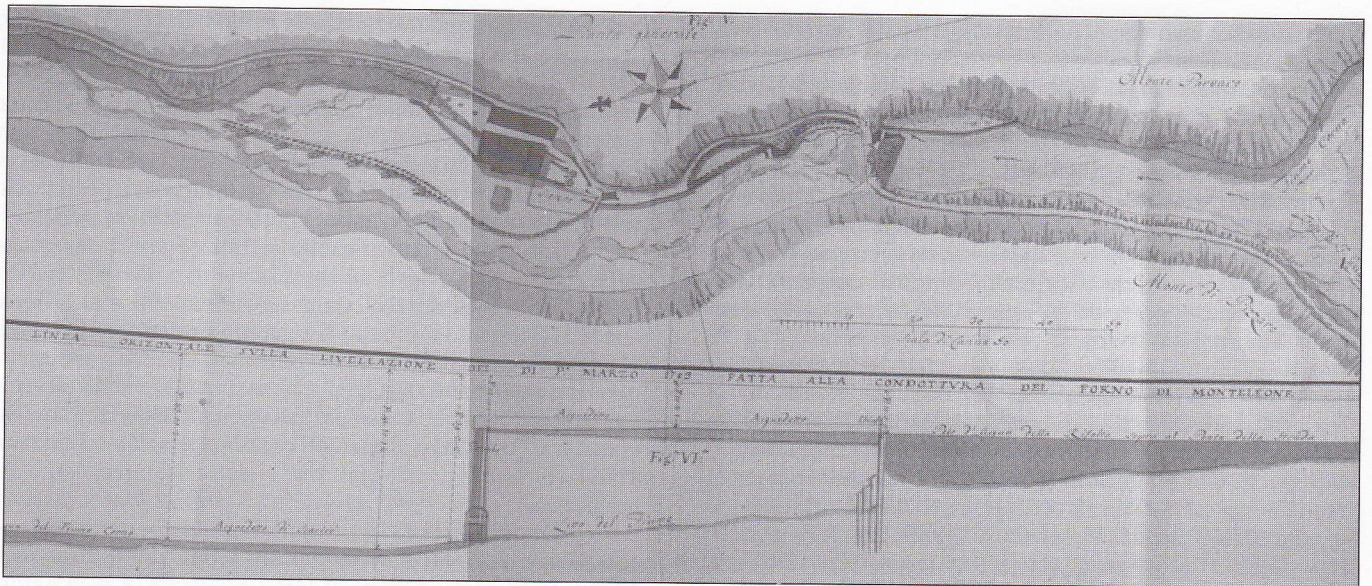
Pianta del sito con il forno di prima fusione e le opere idrauliche.
